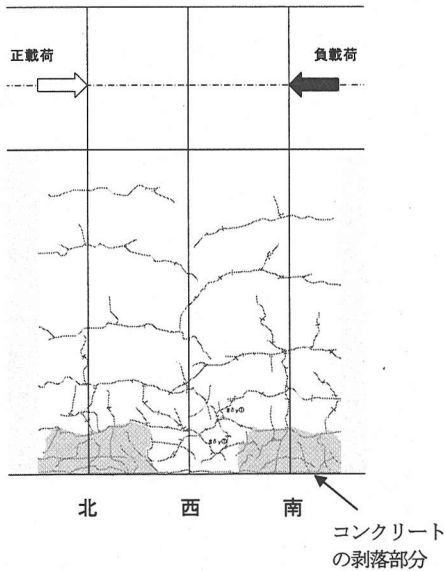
載荷終了時のひび割れ状況 (M-0)
